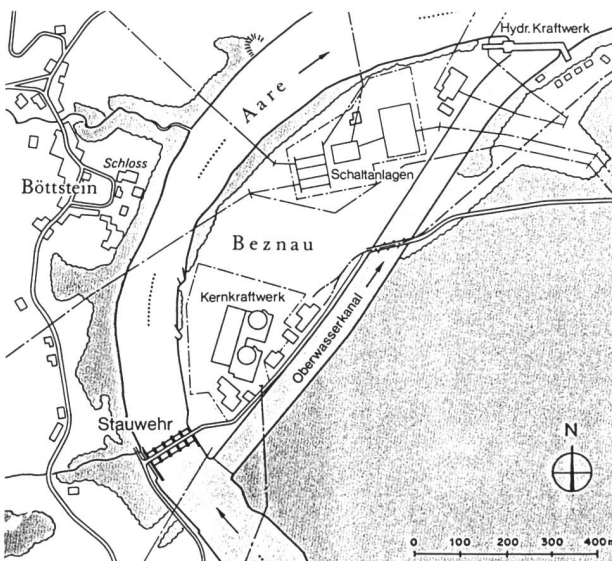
Übersichtsplan des Kraftwerks Beznau mit Stauwehr, Oberwasserkanal und Maschinenhaus.
